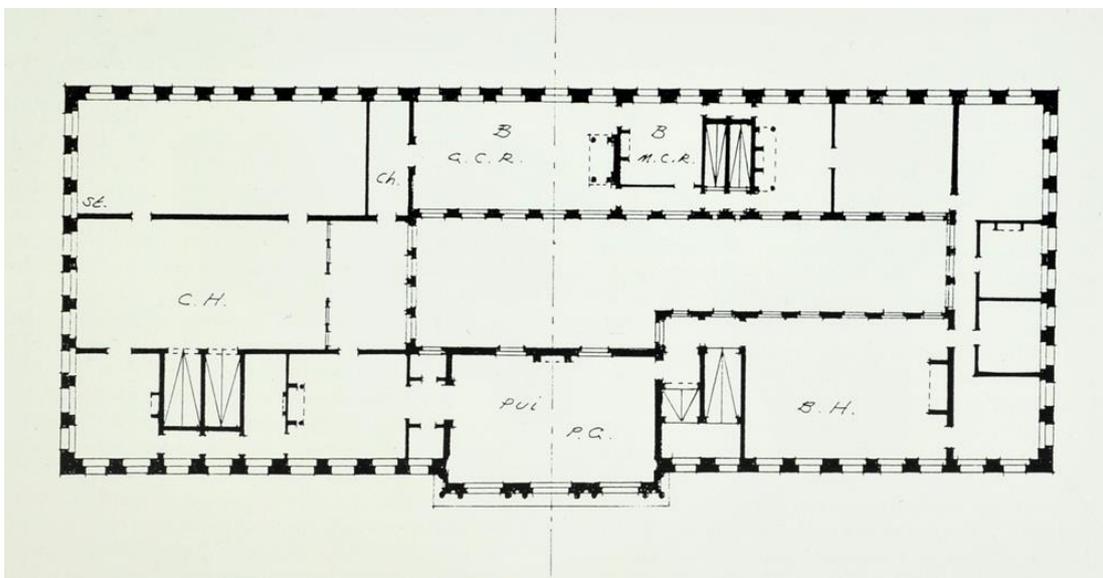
Antwerpen, Rathaus, Grundriss piano nobile (PG - Proclamation gallery; BH - Banqueting Hall; CH - Citizens' Hall; ST - Office stairs; B - Burgomasters' Room; GCR - Greater College Room; MCR - Minor College Room; Ch - Chapel) (aus: Kuyper 1994)
